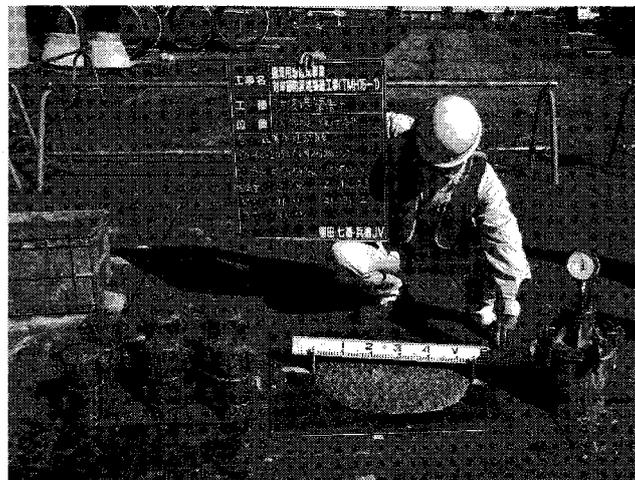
水中不分離コンクリート品質管理試験状況
